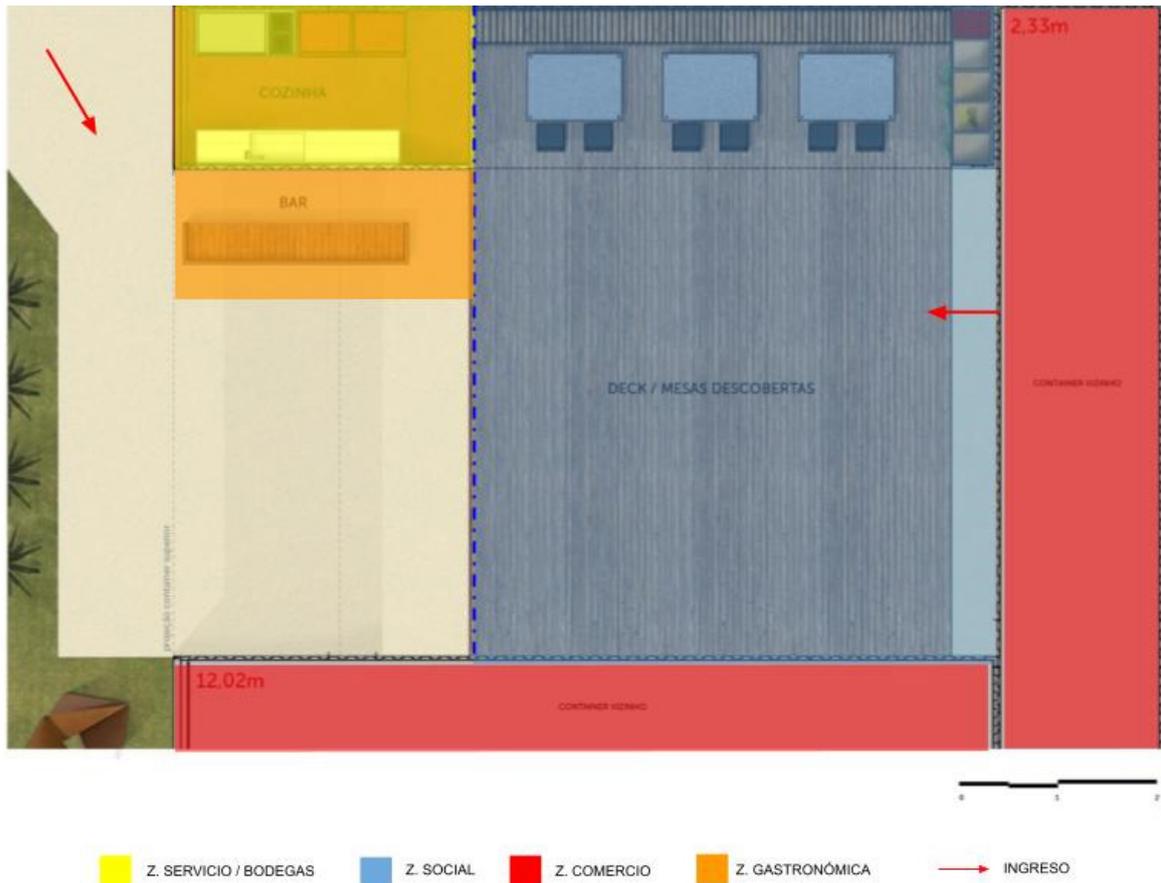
Planta de áreas de Restaurante Container en Minas, Lagoa Santa - Brasil.
